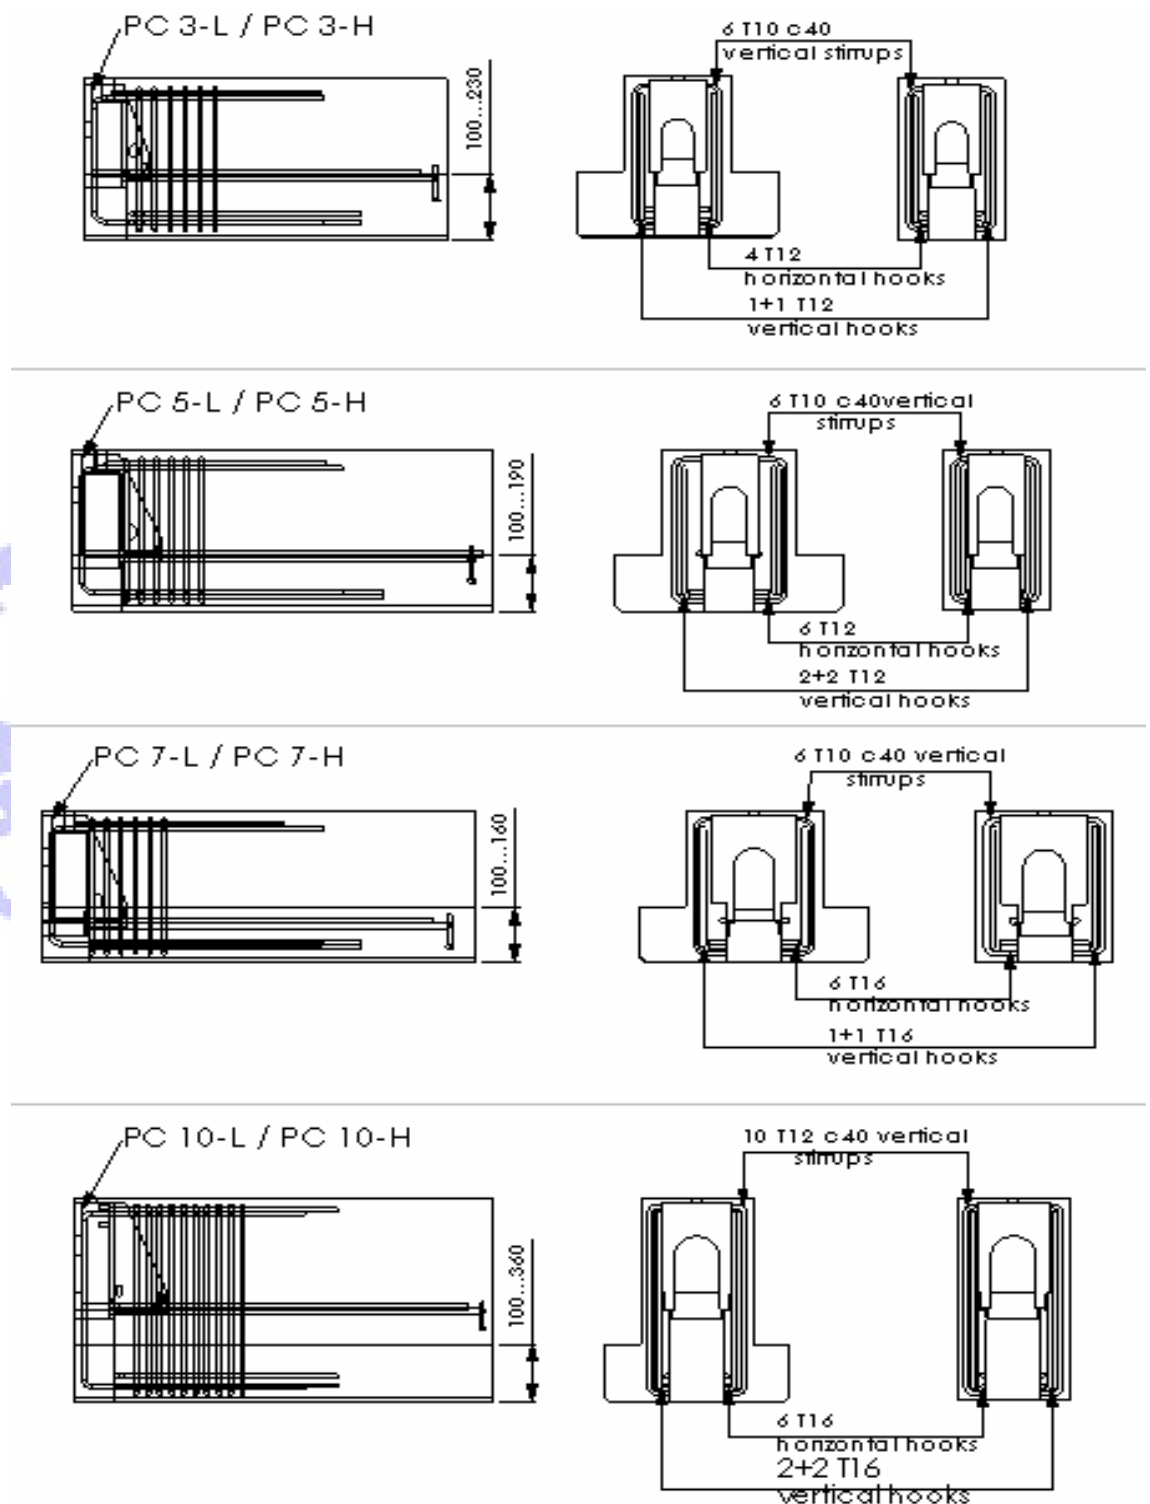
Armadura adicional de la viga para casos en que la distancia entre armaduras del pie de viga y la principal de la viga es superior a 100 mm.
